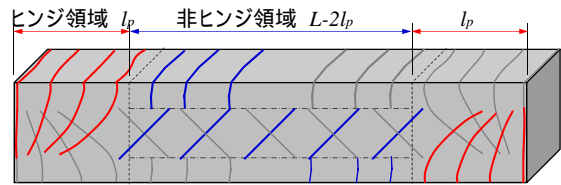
ヒンジ領域と非ヒンジ領域に発生するひび割れ
